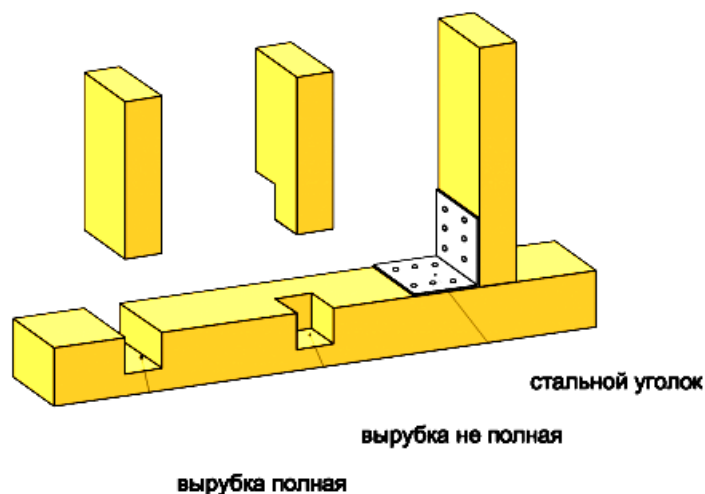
Крепление рядовых стоек каркаса к брусу нижней обвязки
